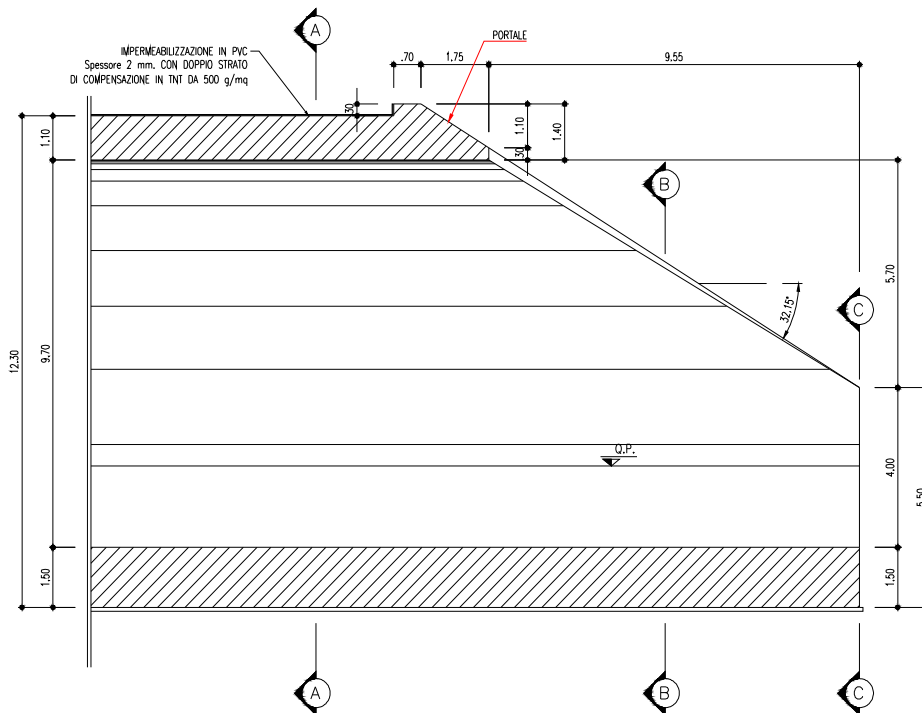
sezione tipo di imbocco PE lato caltanissetta
